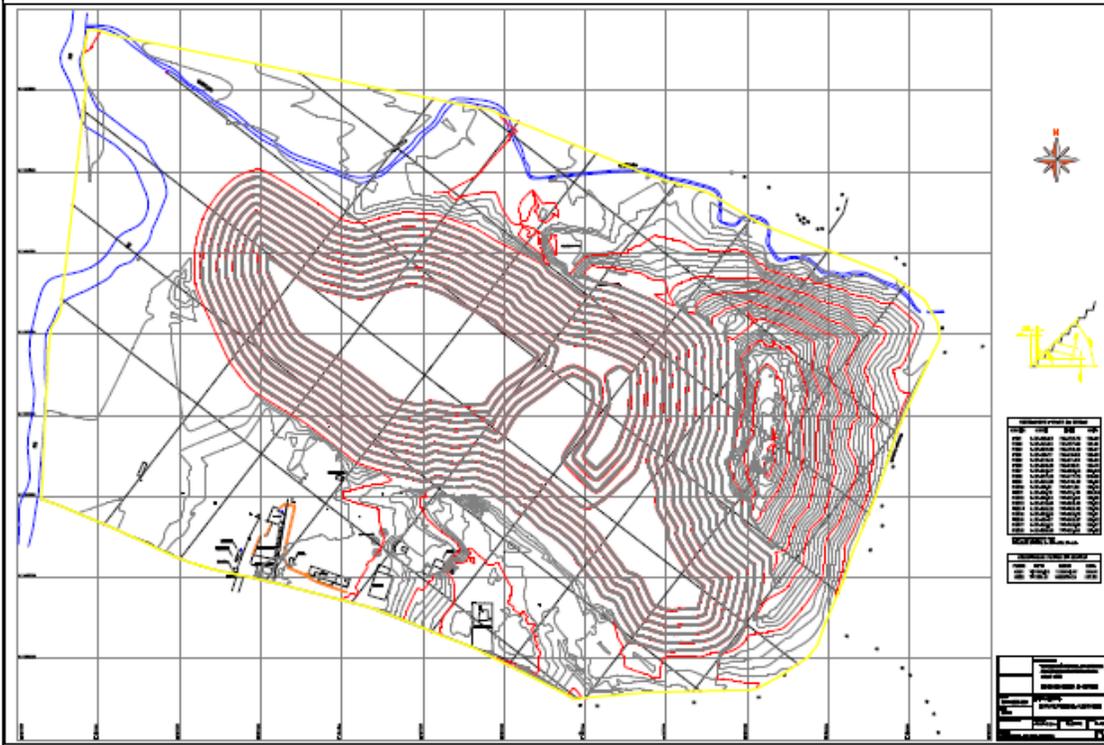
Plano general de la fosa final (Fuente: Propia)
